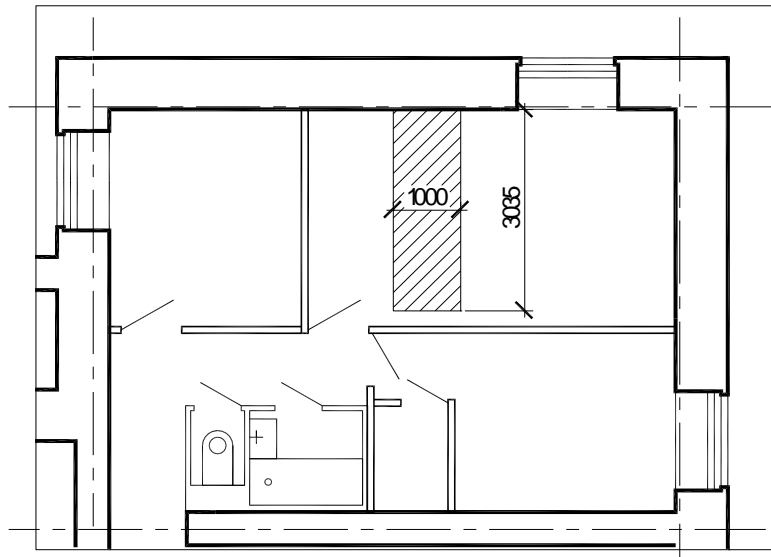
Грузовая площадь для наружной стены 12-этажной секции
